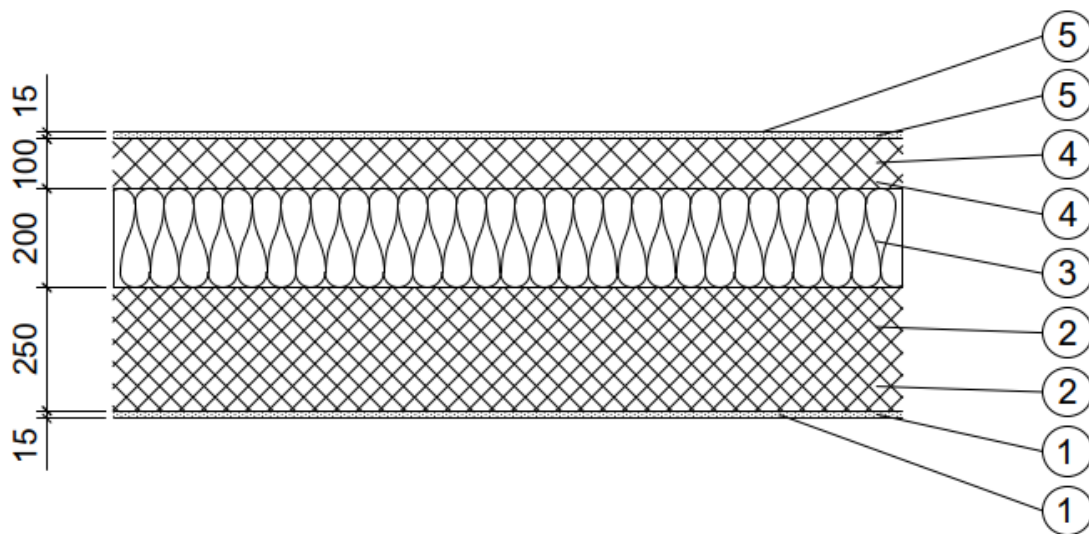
Zweischalige Stahlbetonwand mit Kerndämmung
